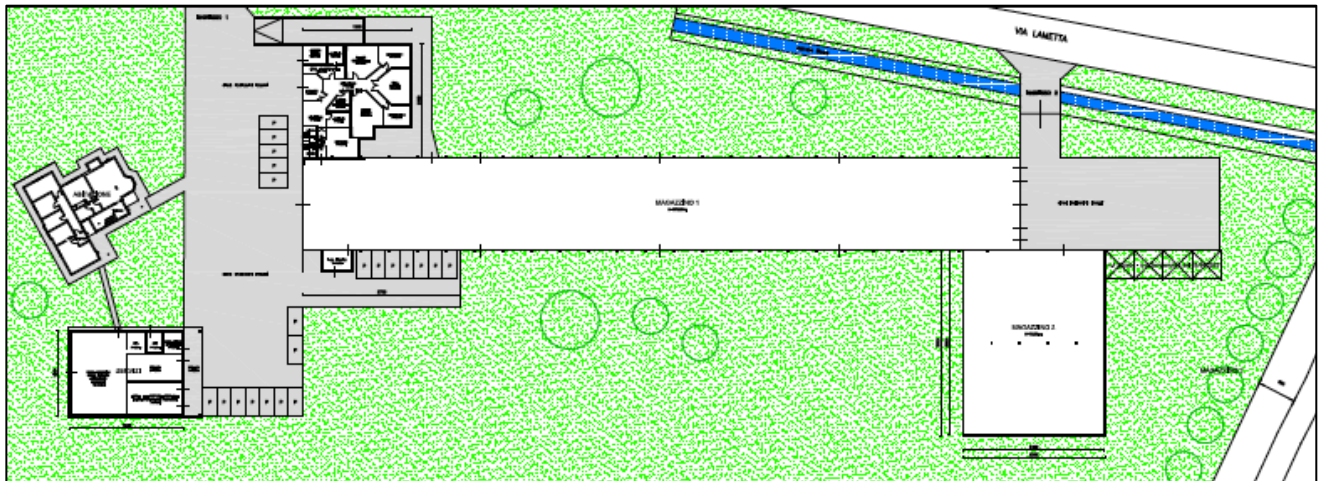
Planimetria generale stato attuale (estratto tavola n.1-pianta legittimato)
